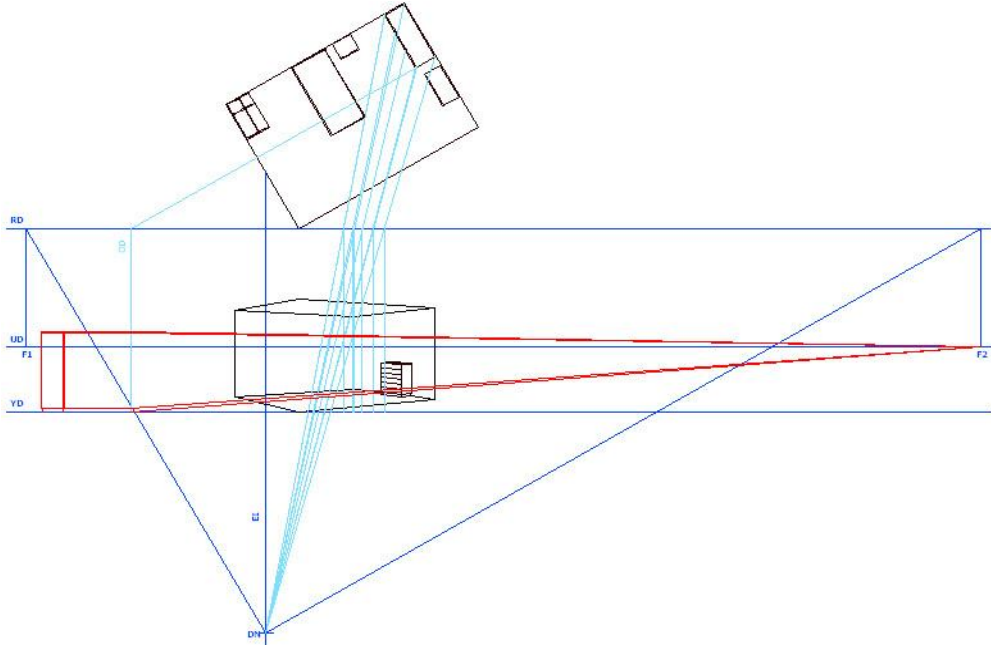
Resim düzlemini kesen ışınların yer düzlemine taşınması
